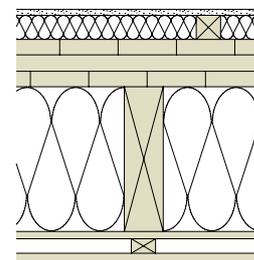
Aufbau Massivholzkonstruktion
